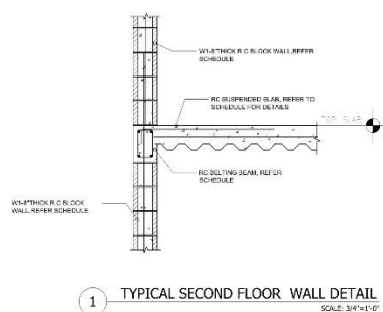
Se requiere de bloques No.8 con detalles en el segundo piso, estos bloques igual que en el segundo piso lleva hierros verticales y horizontales y recalzada con concreto grouting de 3000psi, los muros de particiones llevan insoluciones y con 1/2" de gypsum board o laminas de laminas de sheetrock
